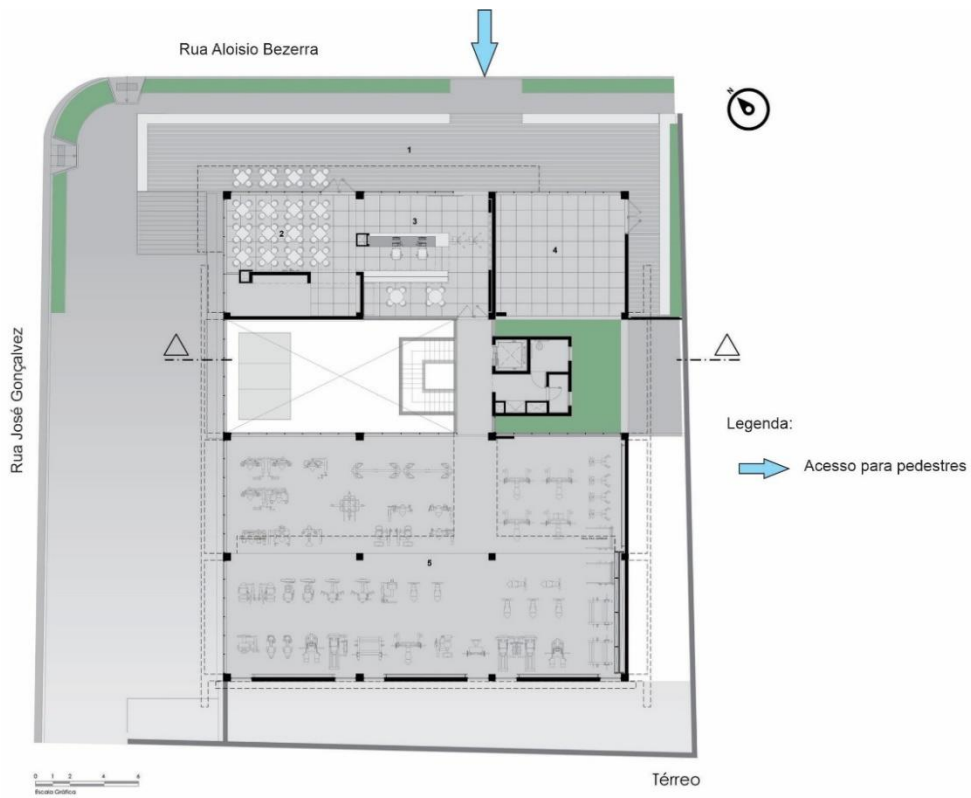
Planta baixa do térreo da academia Pulse Health & Fitness com indicação do acesso. Fonte: Site Archdaily (2014).
